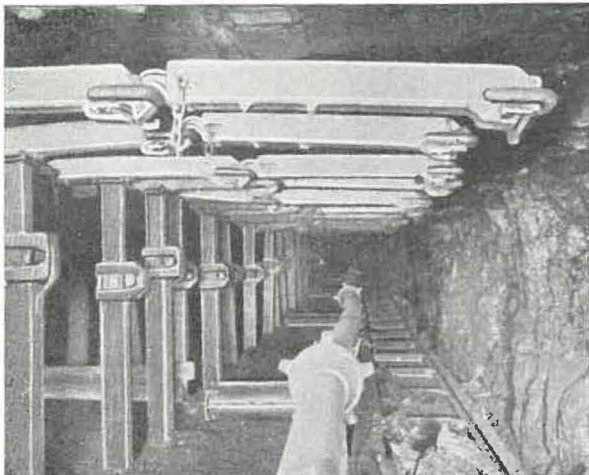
Taille équipée de bèles BE Hakenkappen au siège Sachsen.
